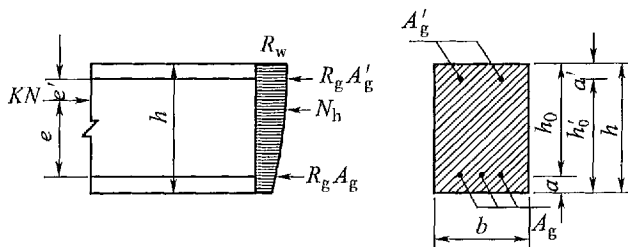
钢筋混凝土小偏心受压构件截面强度计算
